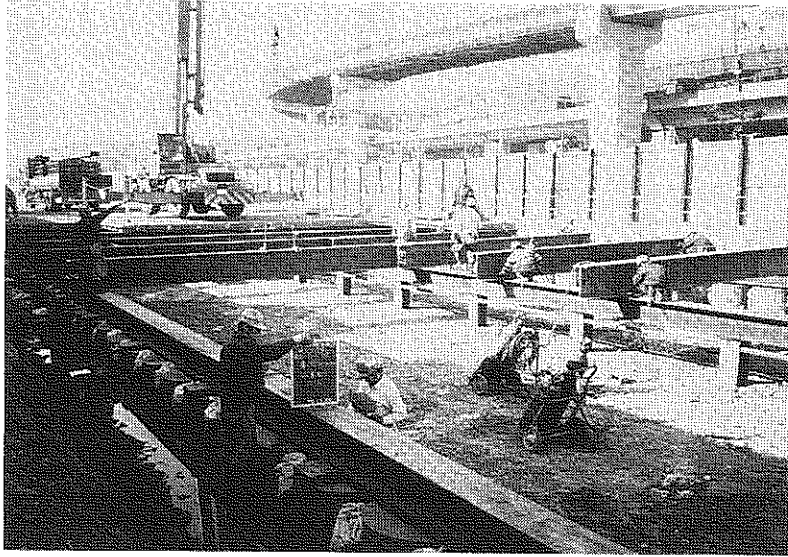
6 - 30 仮設栈橋（全面覆工）施工状況
